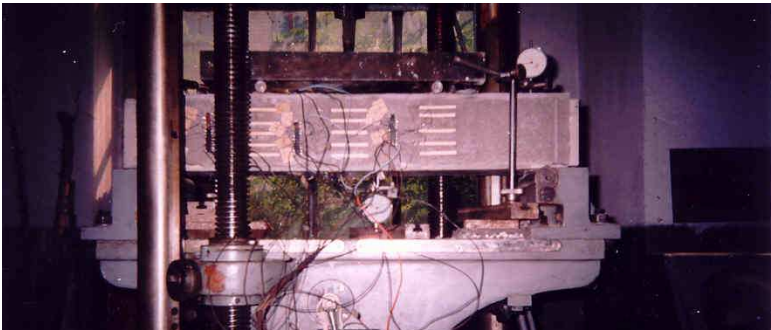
Общий вид установки по испытанию железобетонной балки, усиленной обоймой из акрилового полимерраствора, на изгиб
